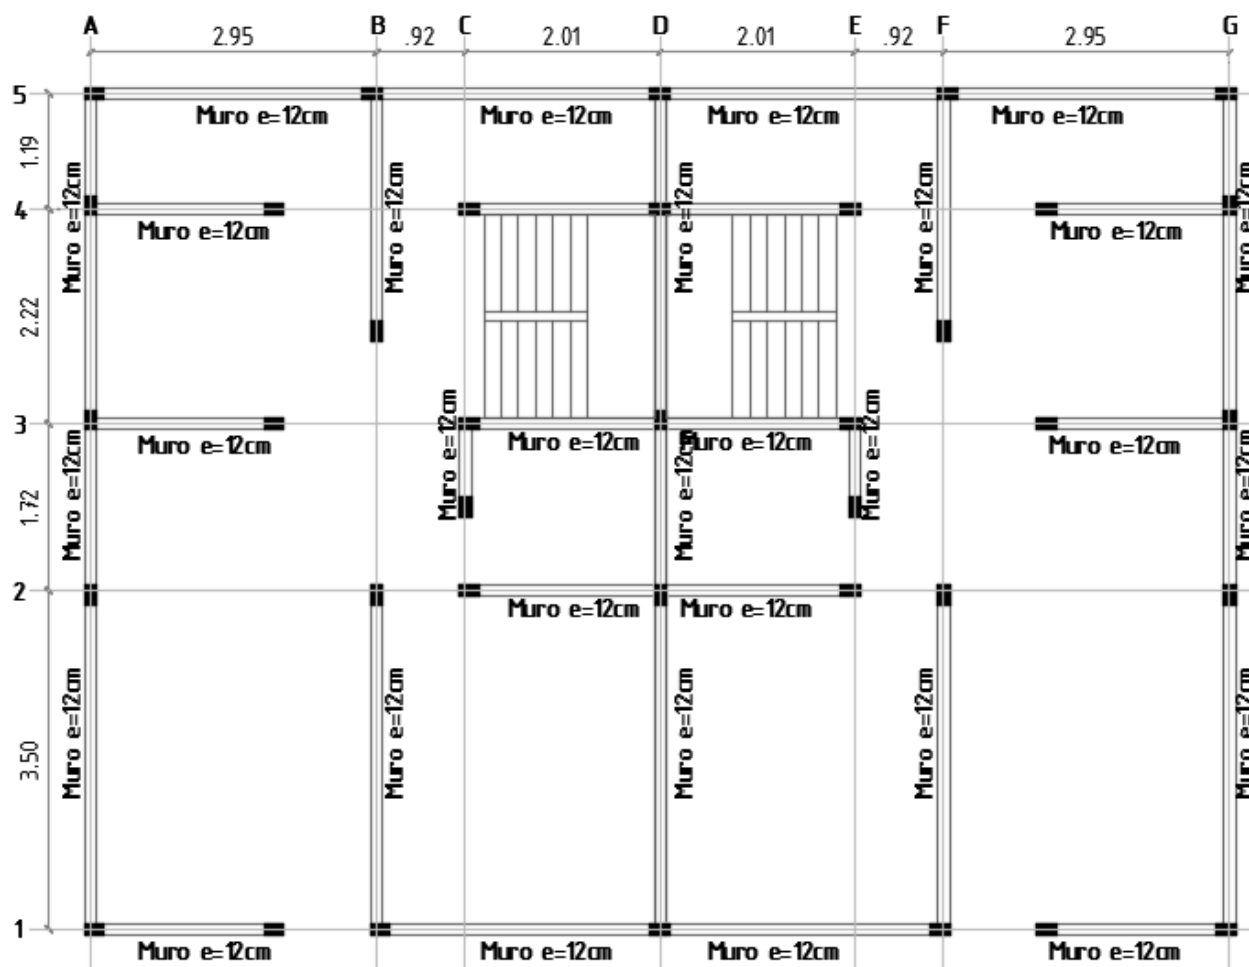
Replanteo estructural muros de mampostería confinada, primer piso
